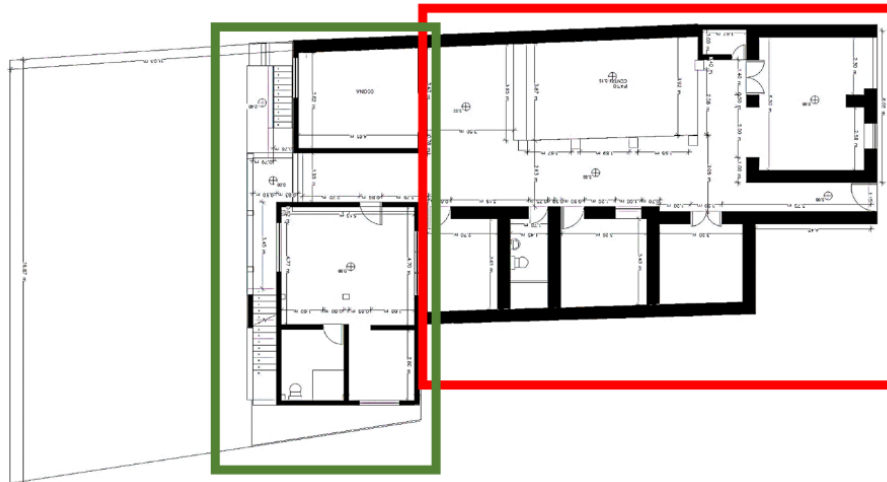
Tipos de sistemas constructivos en el inmueble.
